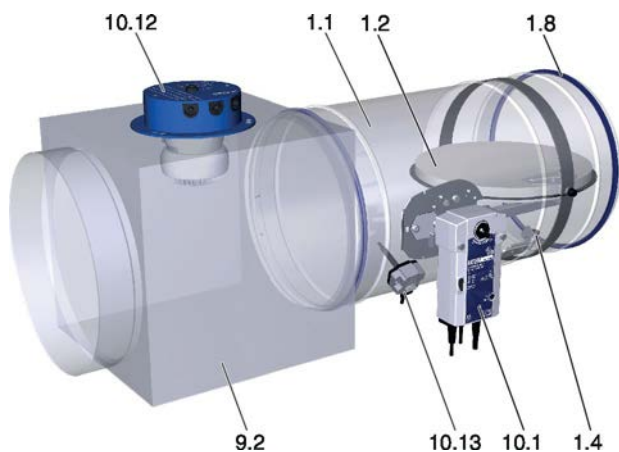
FKR-EU mit Federrücklaufantrieb und Rauchauslöseeinrichtung in einer eckigen Luftleitung
